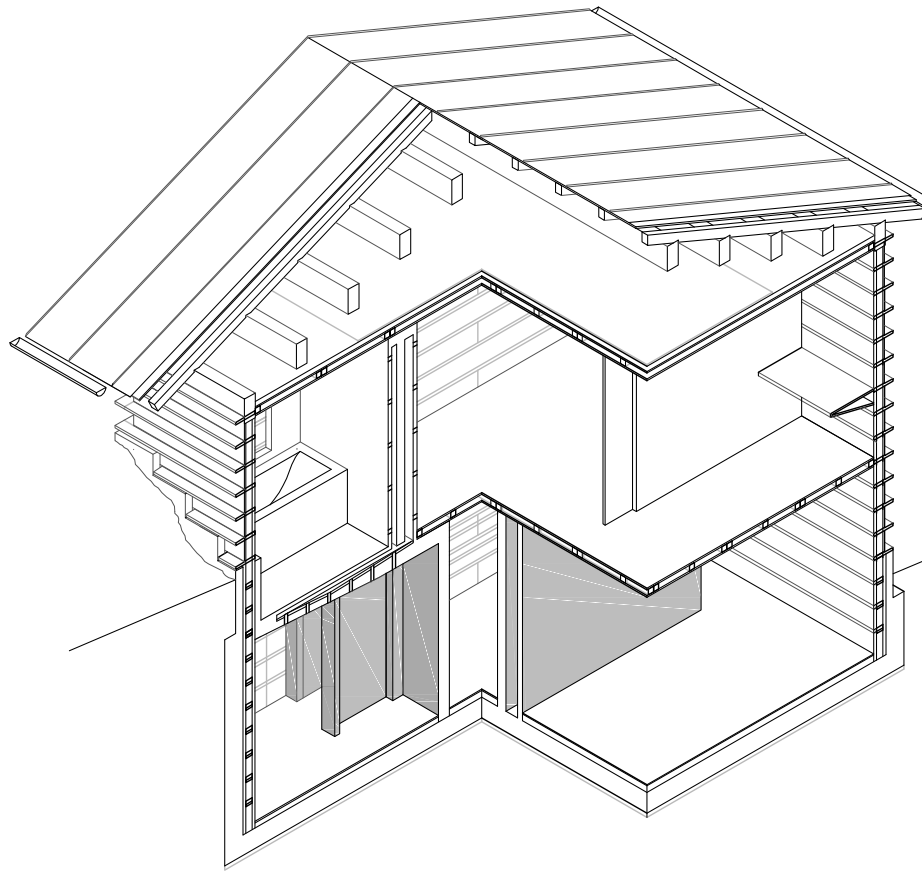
Sistema constructivo de la Casa Gugalun. Axonometría seccionada. Escala 1:100. Elaboración propia.
